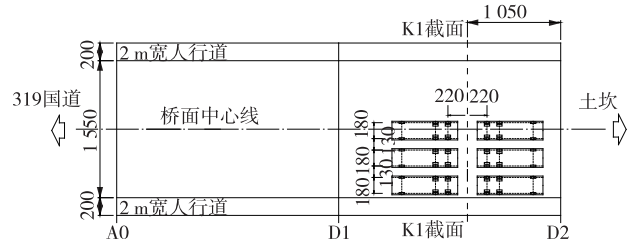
30 m 预应力砼 T 梁 K1 截面 3 列车正、偏载布载示意图(单位:cm)
